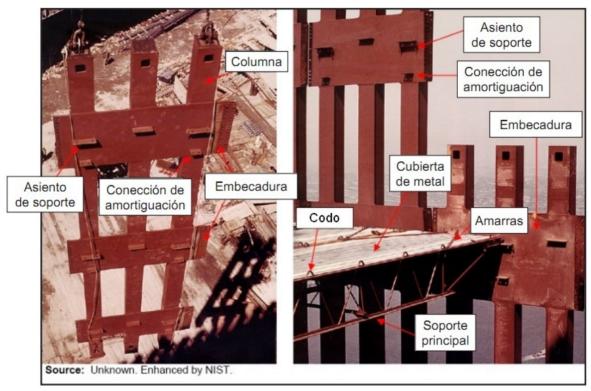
Ensamblaje entre la pared de soporte y la estructura del piso
